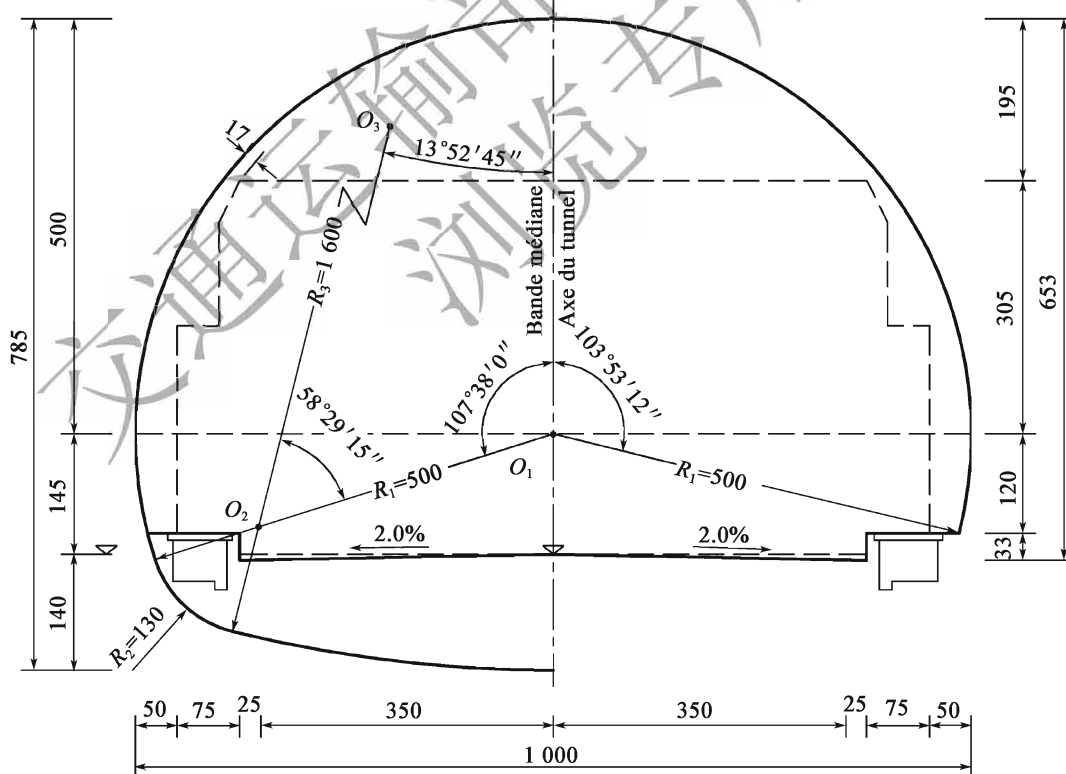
Gabarit du tunnel routier de troisième classe à deux voies (40km/h) (unité:cm)
